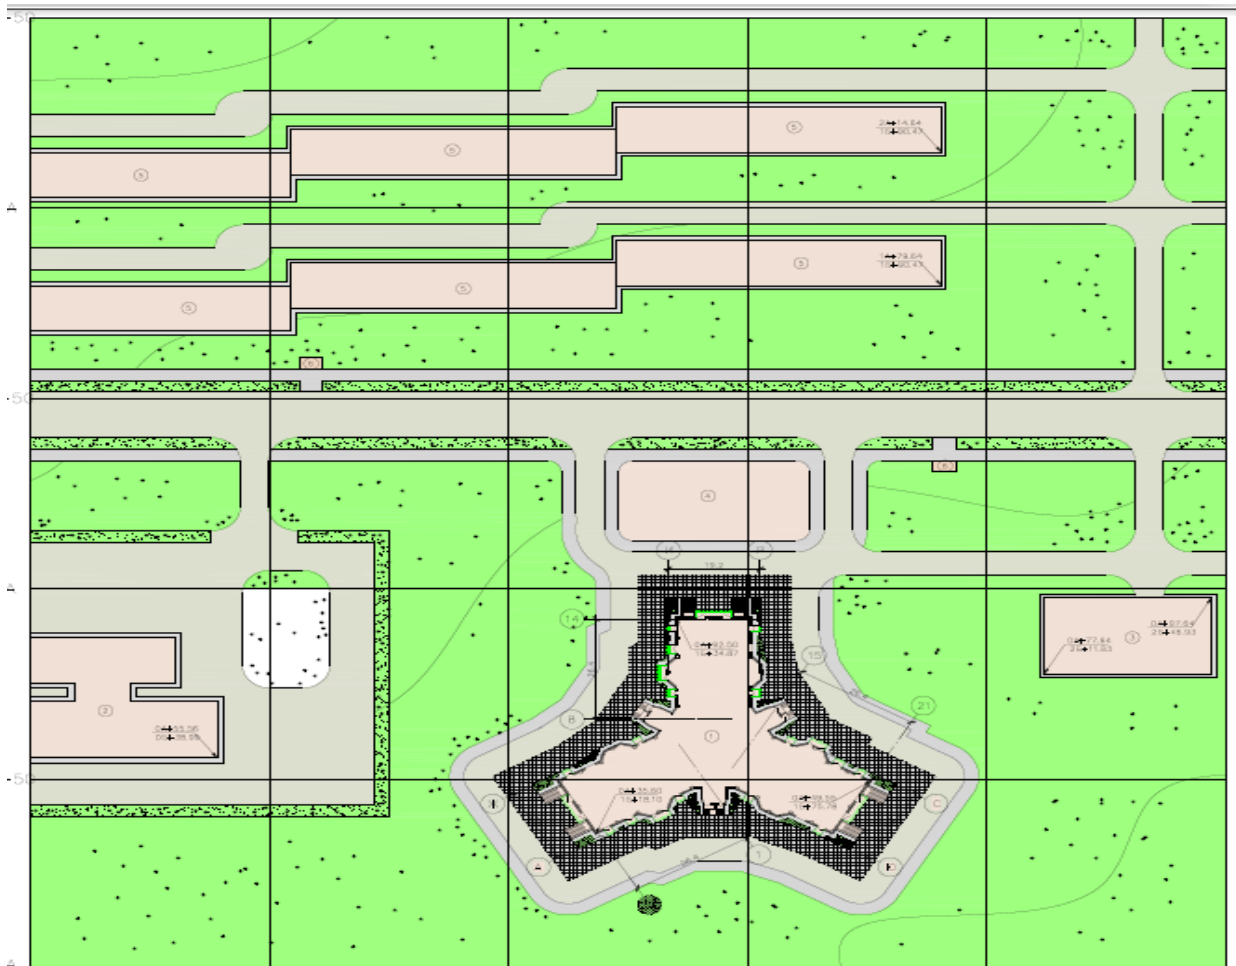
Ситуаційна схема: 1– 24-х поверхова будівля, 2 – школа, 3 –гараж, 4 – майданчик для дітей, 5 – 9-ти поверхова житлова будівля, 6 – зупинка.
